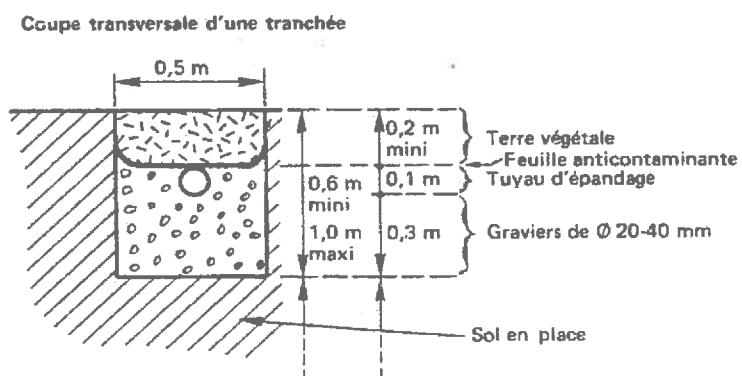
Schéma de principe d'une installation d'assainissement – extrait du DTU 64-1
